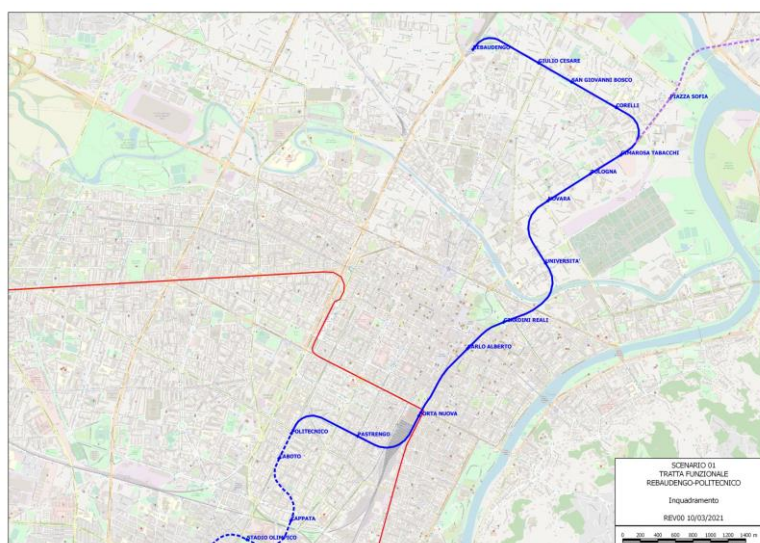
Key-plan della linea 2 – 1° Lotto Funzionale Politecnico – Rebaudengo – Revisione del PFTE
